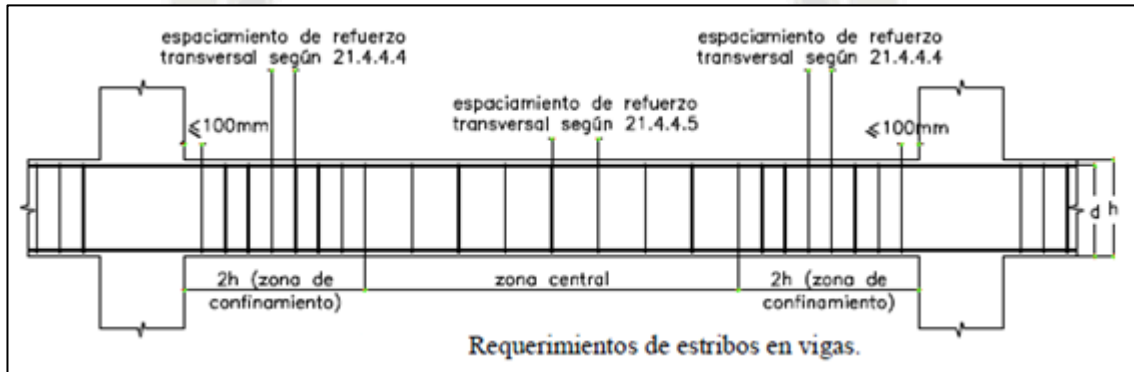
Disposición de estribos en zona de confinamiento y fuera de ella.
